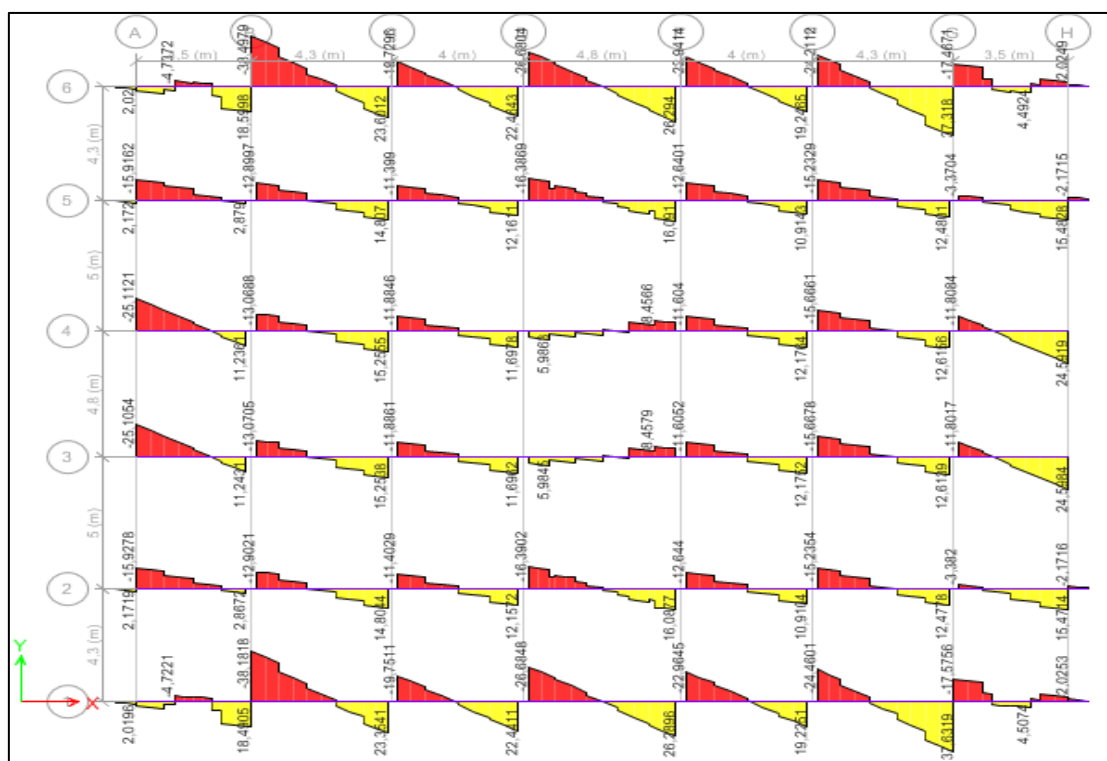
Effort tranchant des poutres secondaires (ELU)
